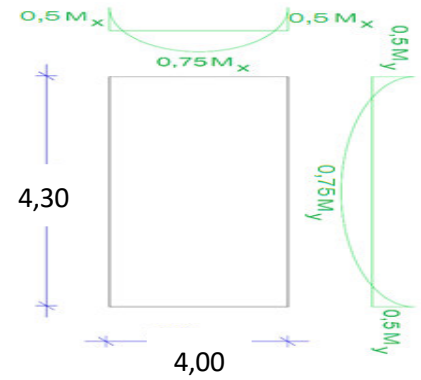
Schéma du panneau de la dalle appuyé sur 4 coté.
